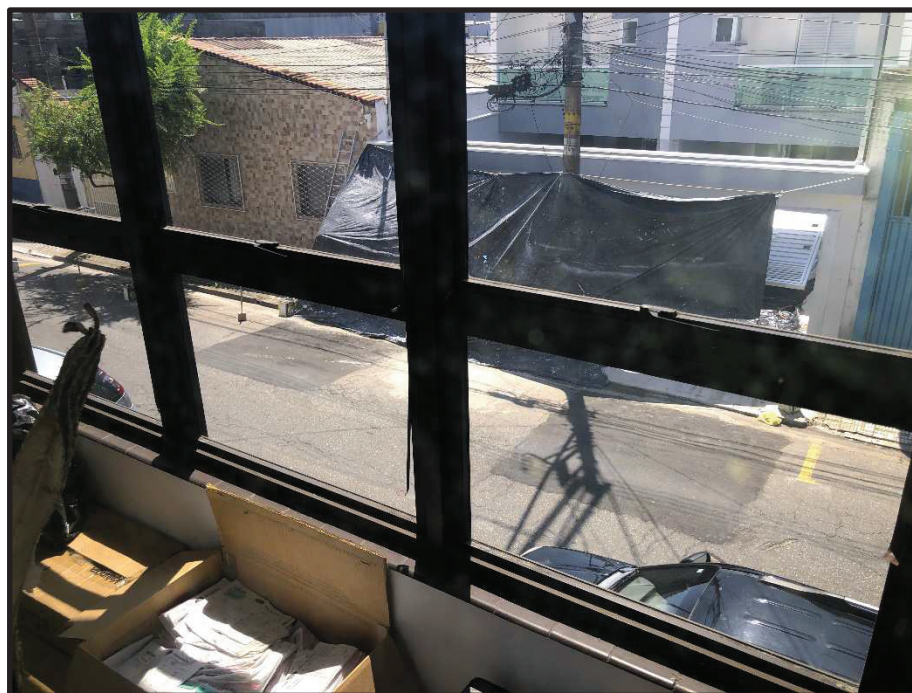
1º Pavimento – Escritório 2 – Sacada
